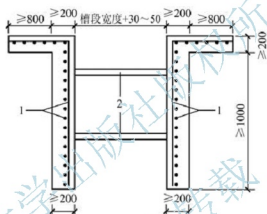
倒 L 形导墙配筋构造图 (单位: mm)
